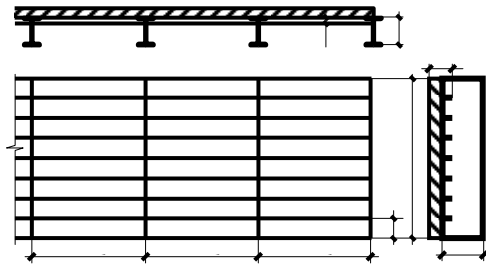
Схема конструкції сталезалізобетонної ортотропної плити
